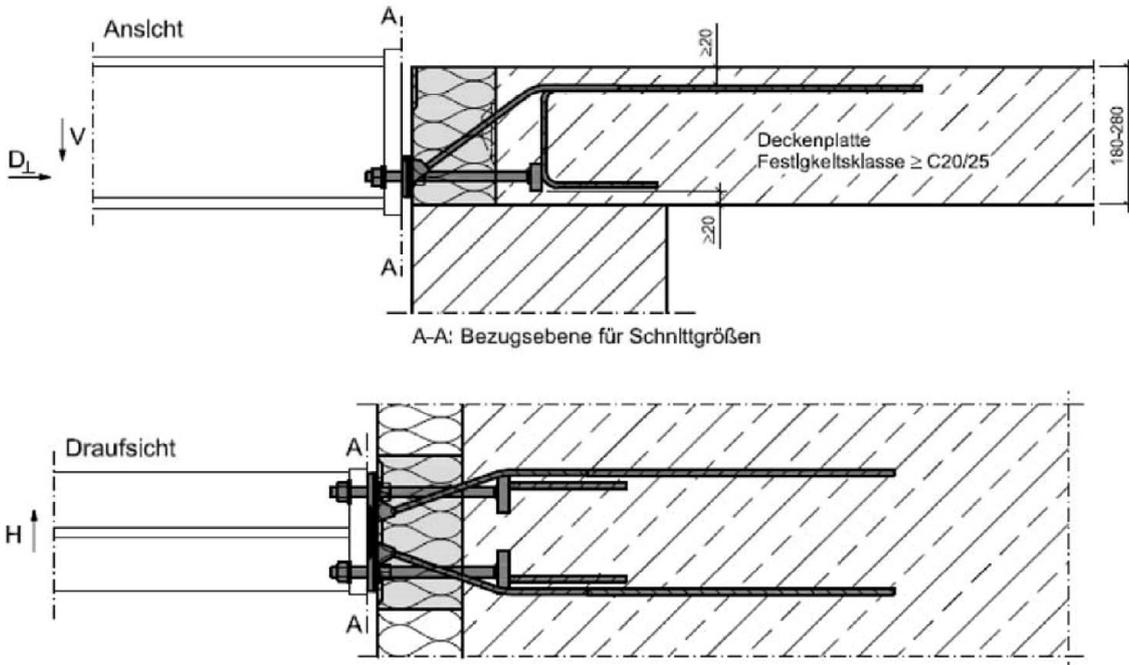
und 76: Schöck Isokorb® XT Typ SQ-V1, XT Typ SQ-V2 und XT Typ SQ-V3, Schnittgrößendefinition
